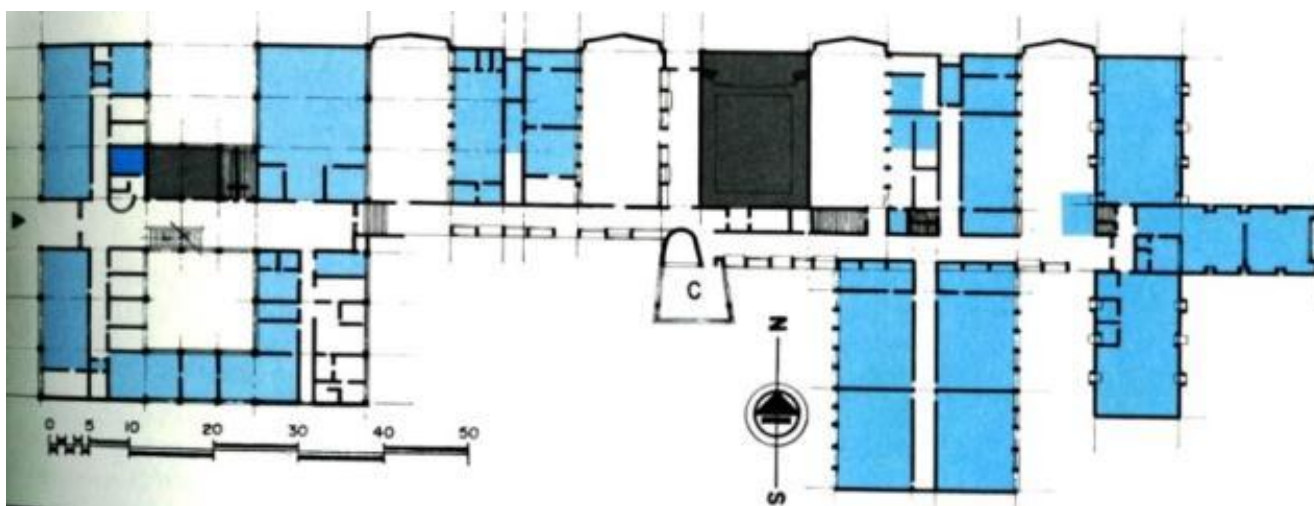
Planta del proyecto original y vistas exteriores. Fotografías CNM.
